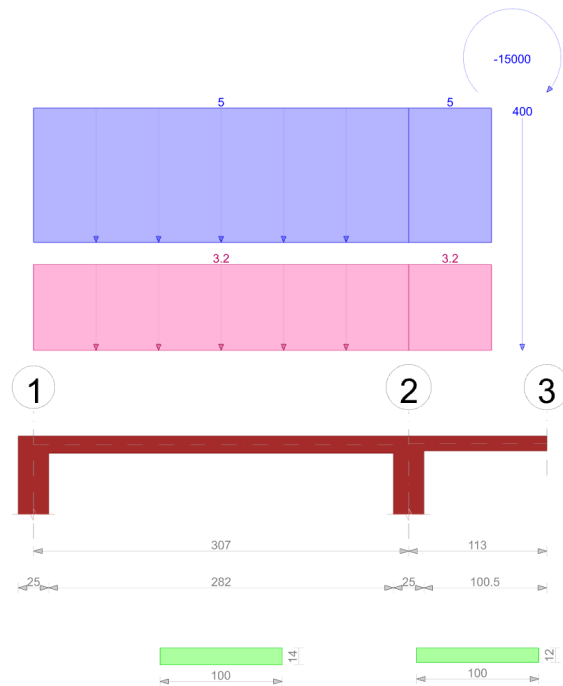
Schema statico della soletta con sbalzo, sezioni e carichi
